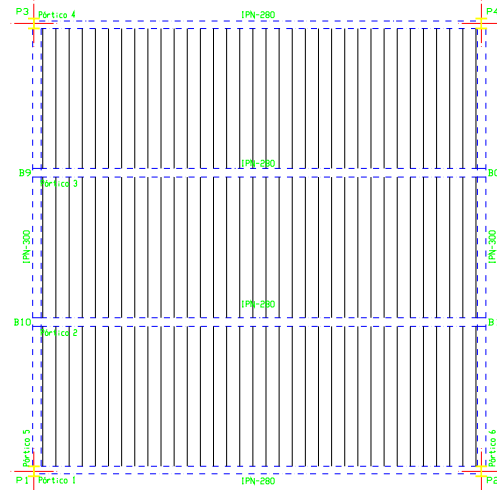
Vista en planta de forjado mixto de chapa colaborante
